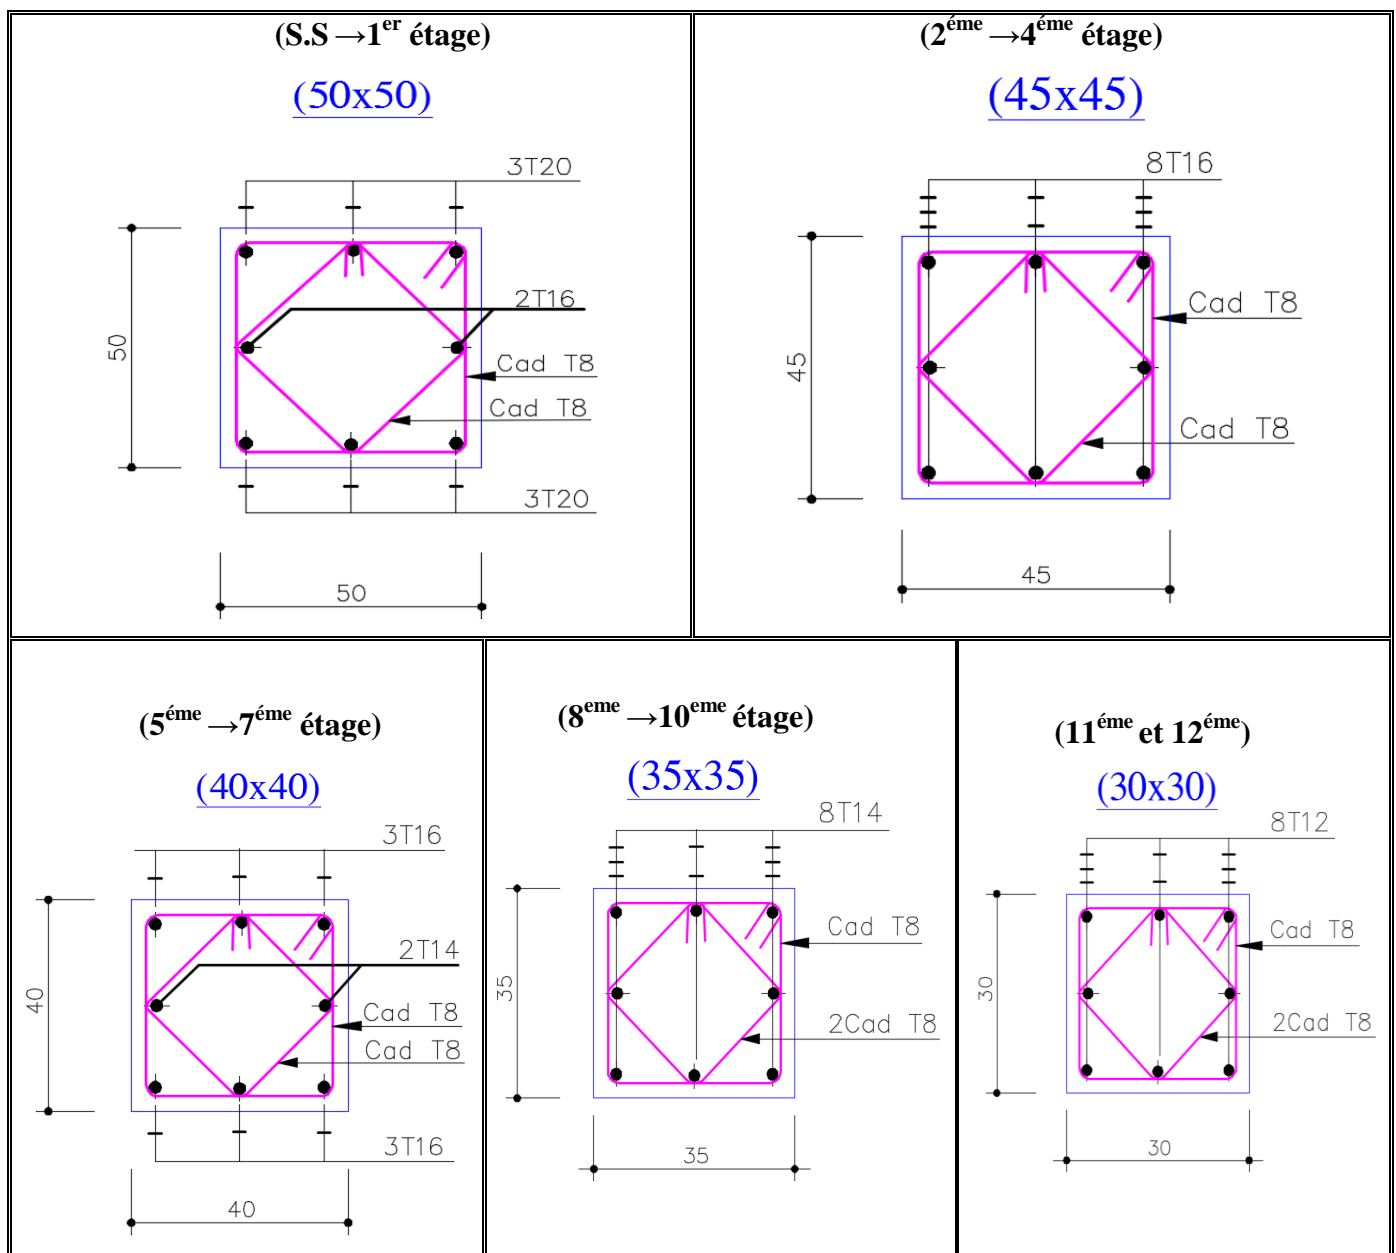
Dessin de ferrailages des sections des poteaux.
